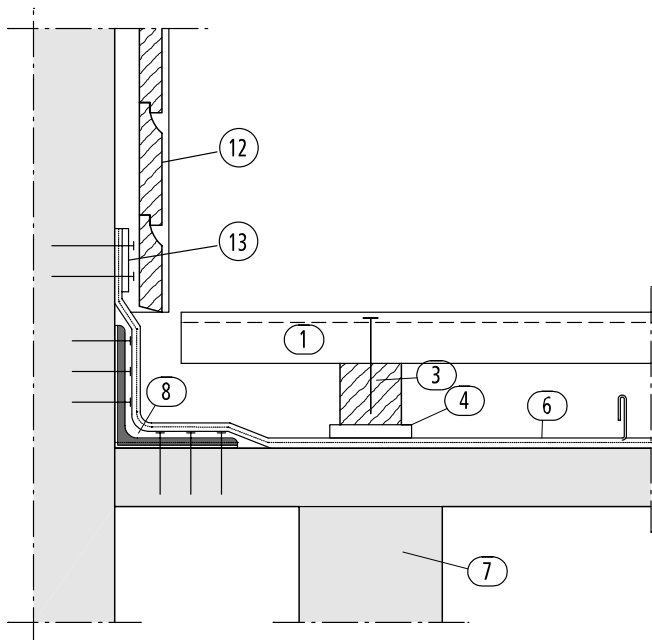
Detailschnitt Bohlenrost mit Blechabdichtung: Geh- und Radwegbrücke
